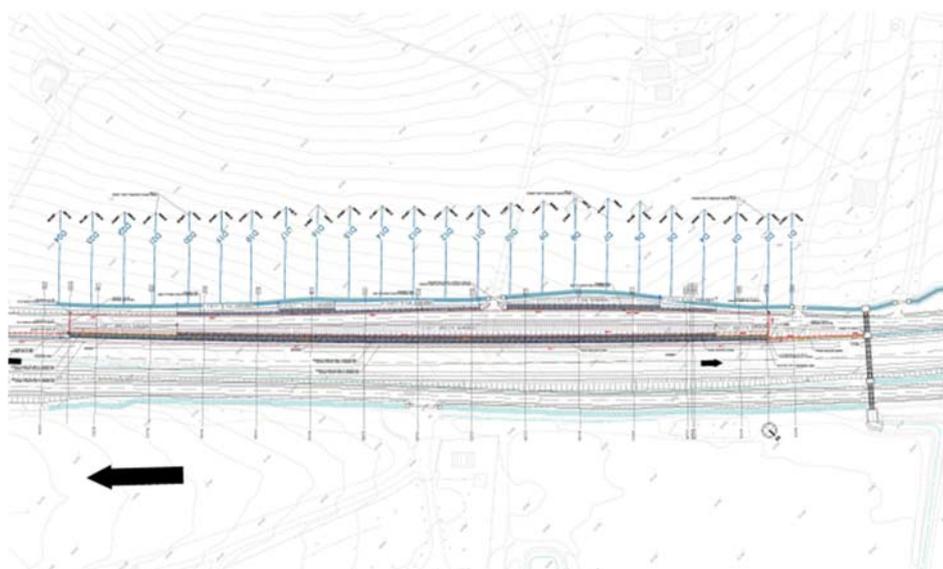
Stralcio planimetrico configurazione con trincee drenanti lungo il pendio
